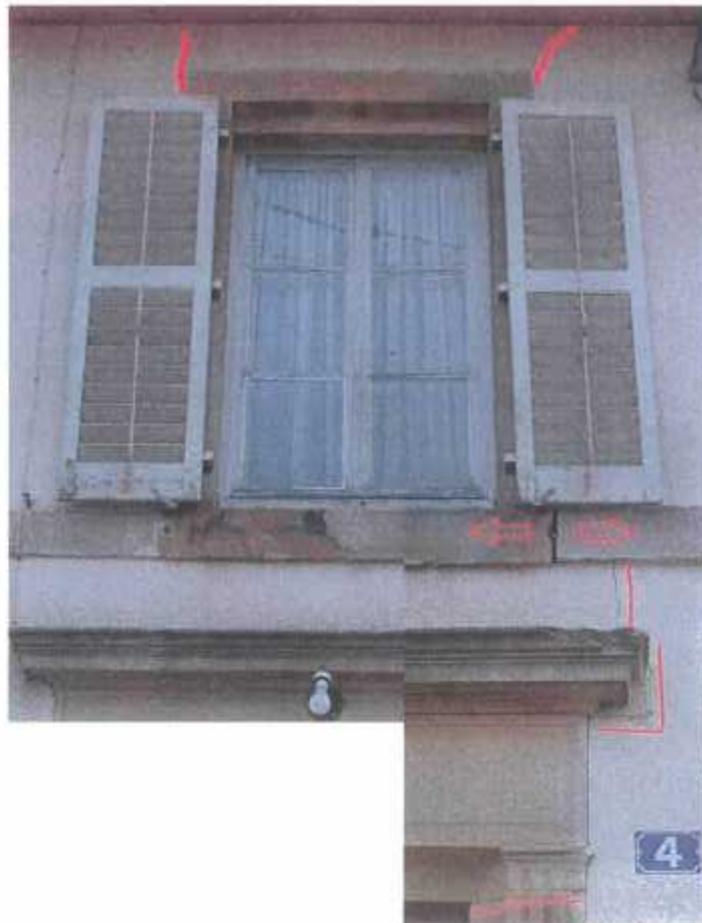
Fissuration sur pierres d'angle – Maison tout venant – Détail
